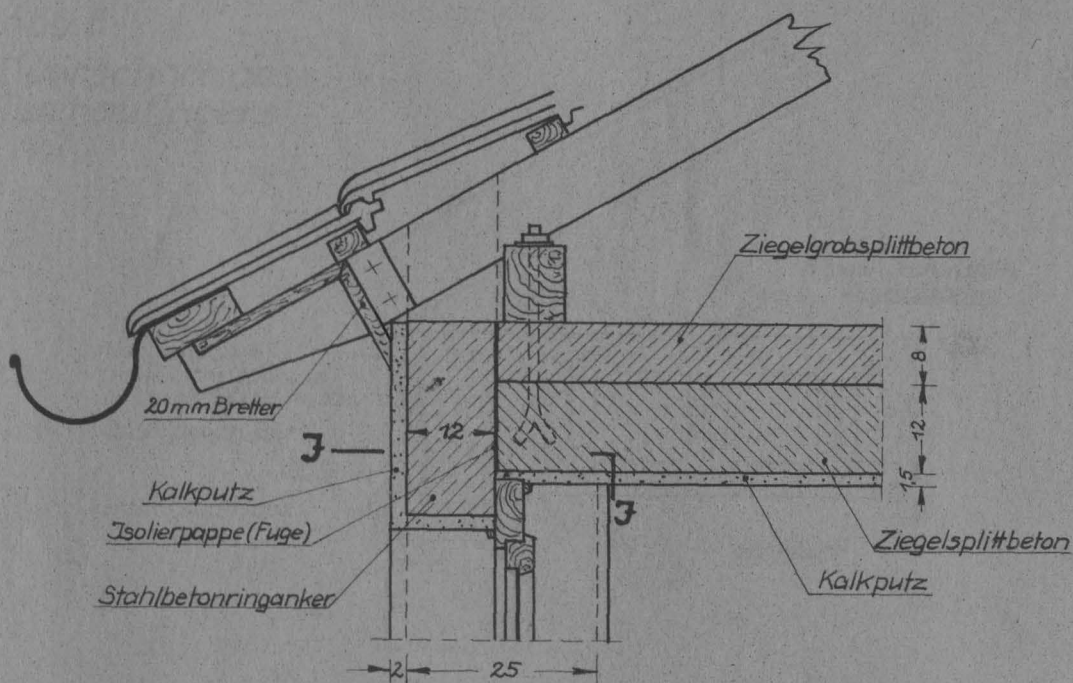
Querschnitt der Dachauflagerung (Typ C)
